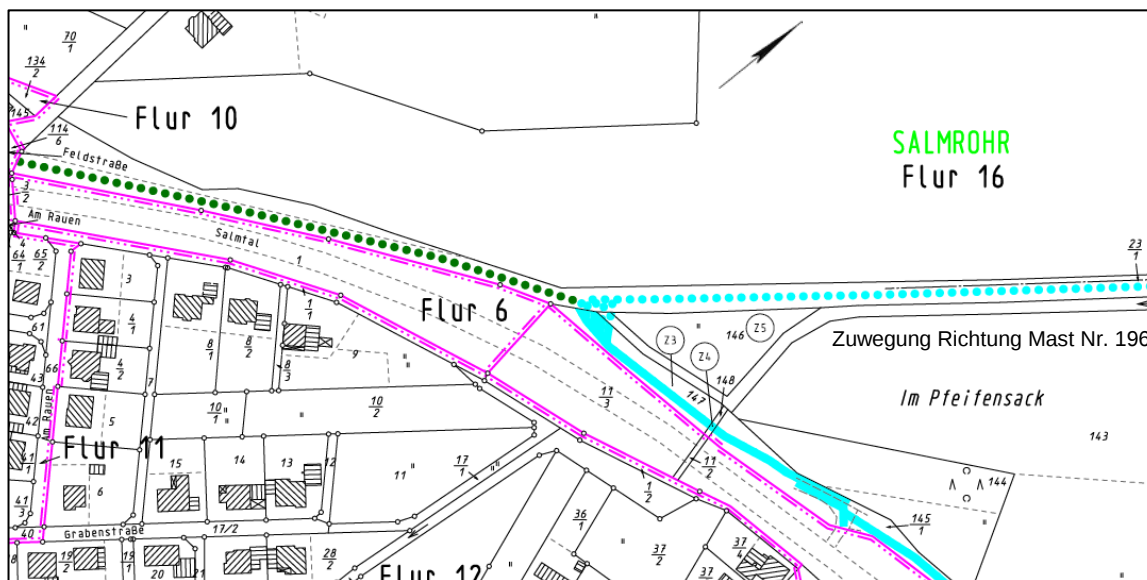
Lageplanausschnitt der Erweiterung der Zuwegung zu Mast Nr. 196.
